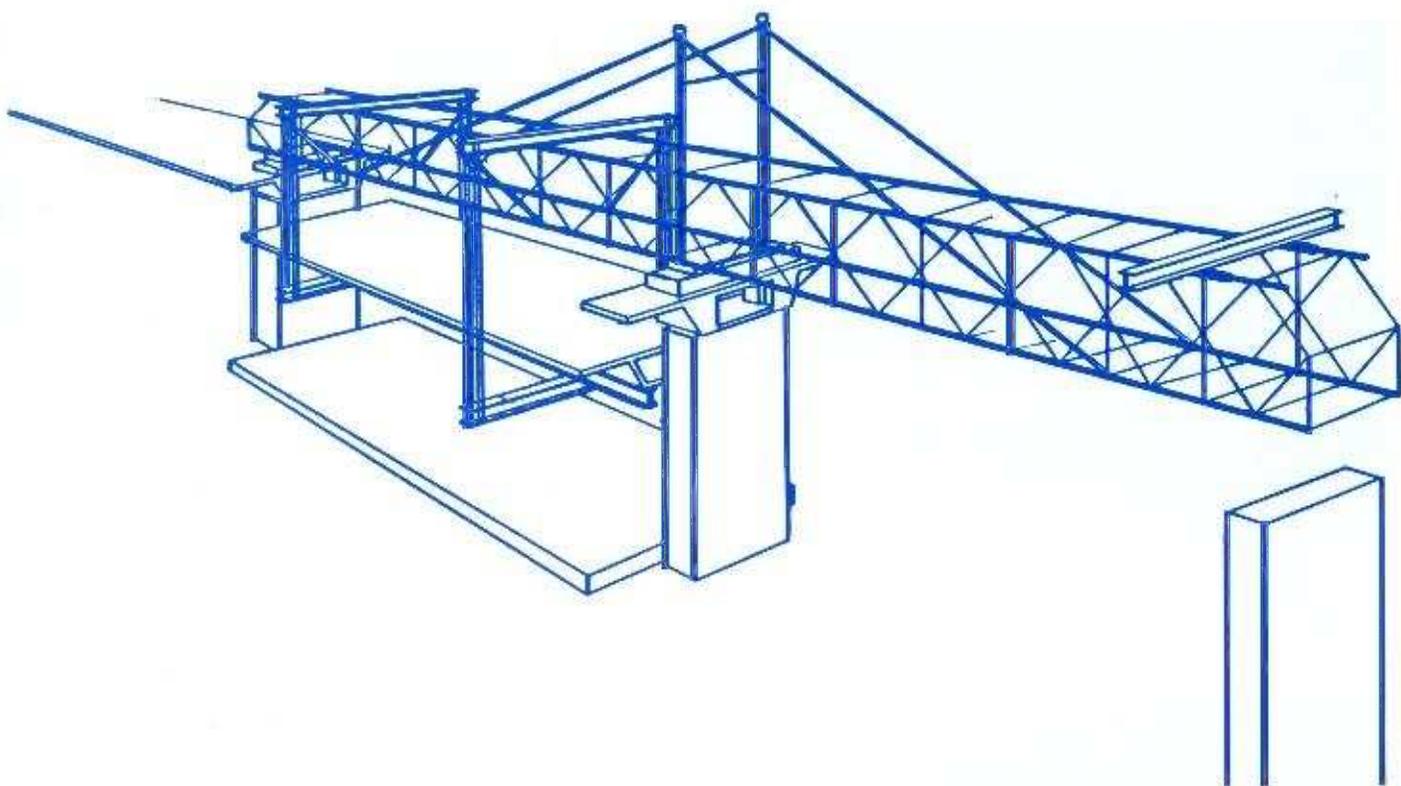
Construction de Seven Mile Bridge. Mise en place des voussoirs préassemblés.
